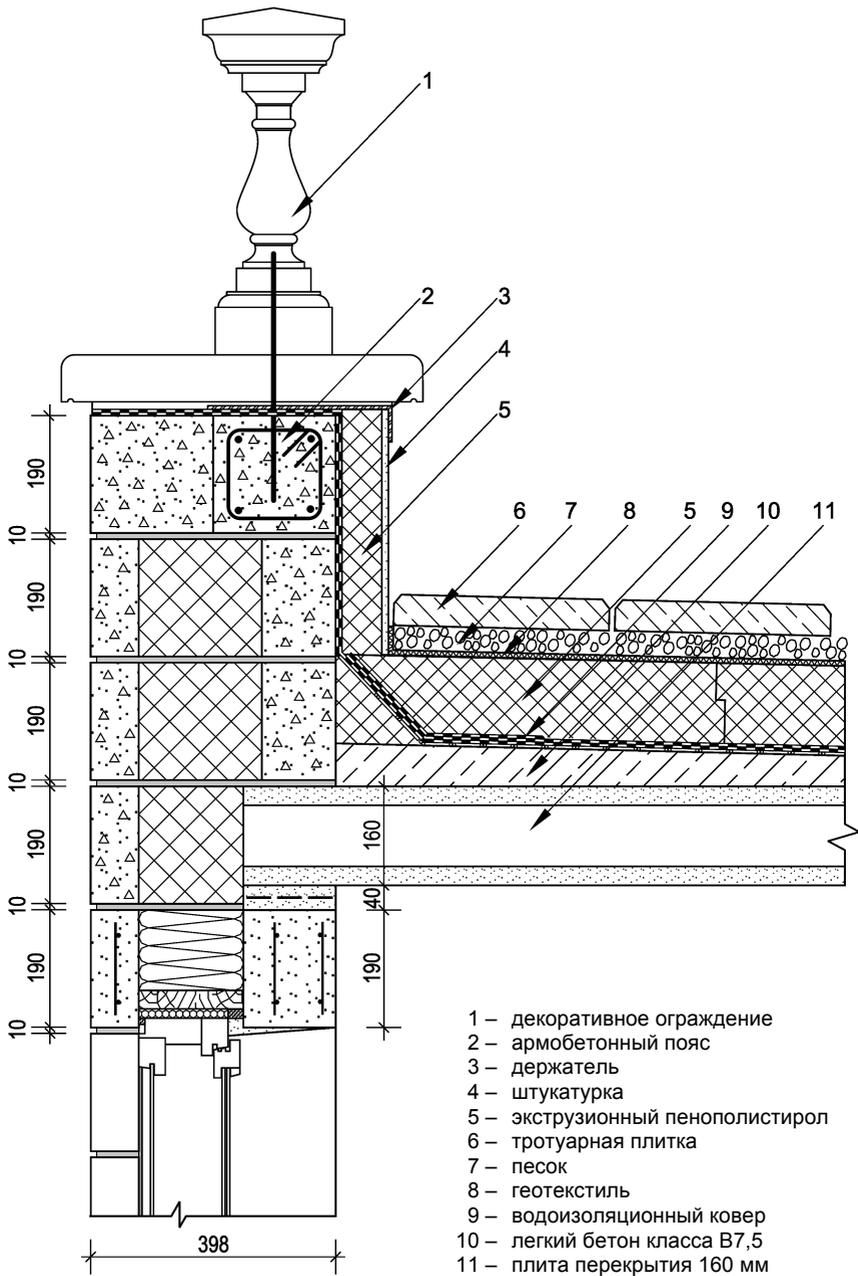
Сопряжение наружной стены из трехслойных блоков с плоской инверсионной кровлей
